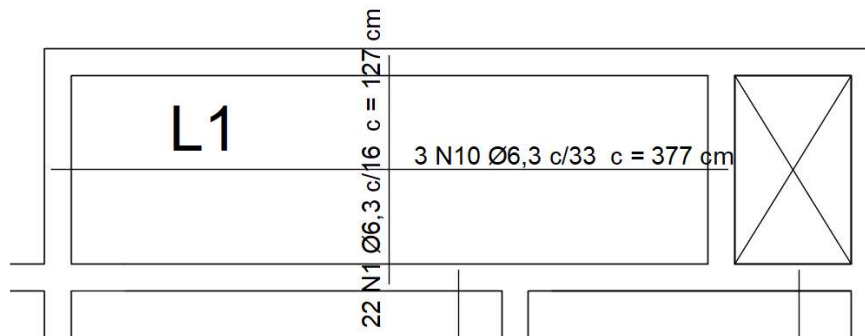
Croqui armaduras positivas de aço da laje L1
